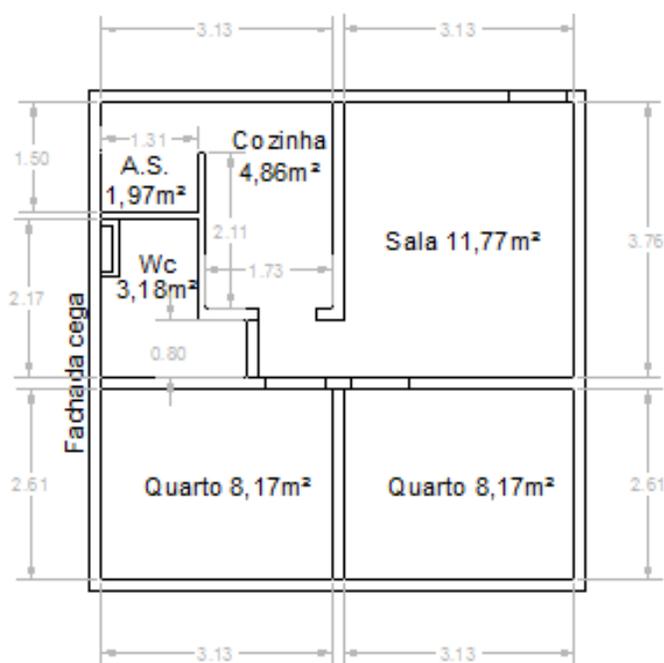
Planta tipologia VI22F-V2 F1 e F2/F3– Apartamento com 37,81m² de área útil
